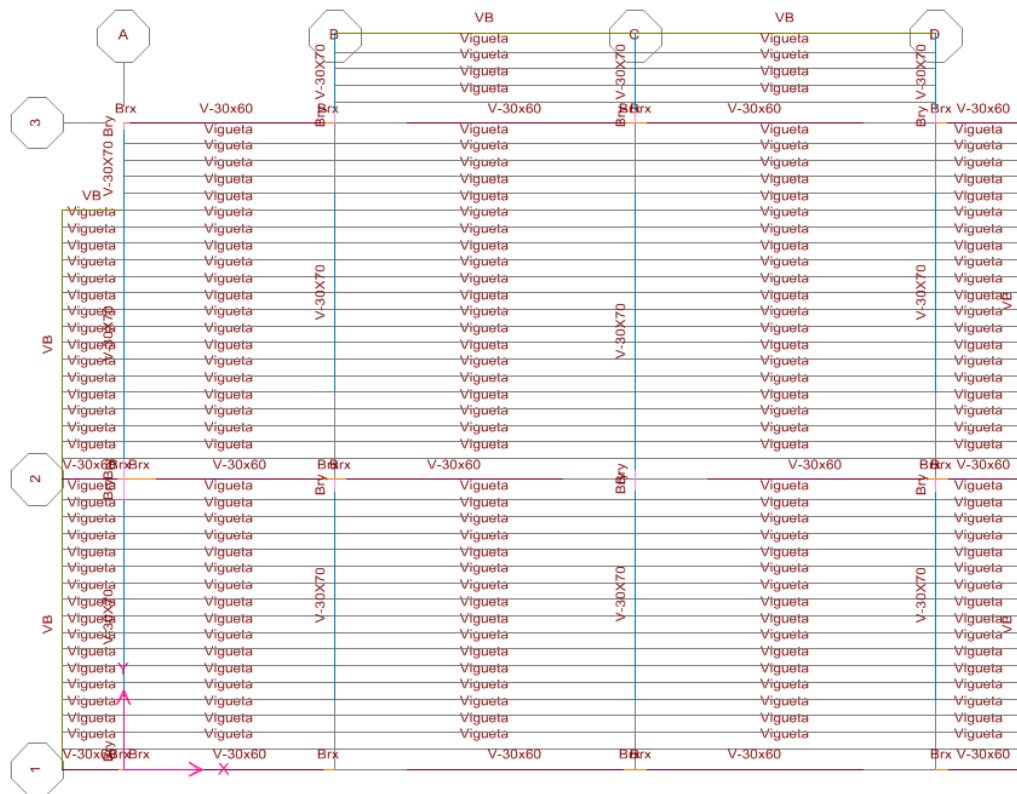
Modelación de la losa unidireccional h: 30 cm-sap2000
